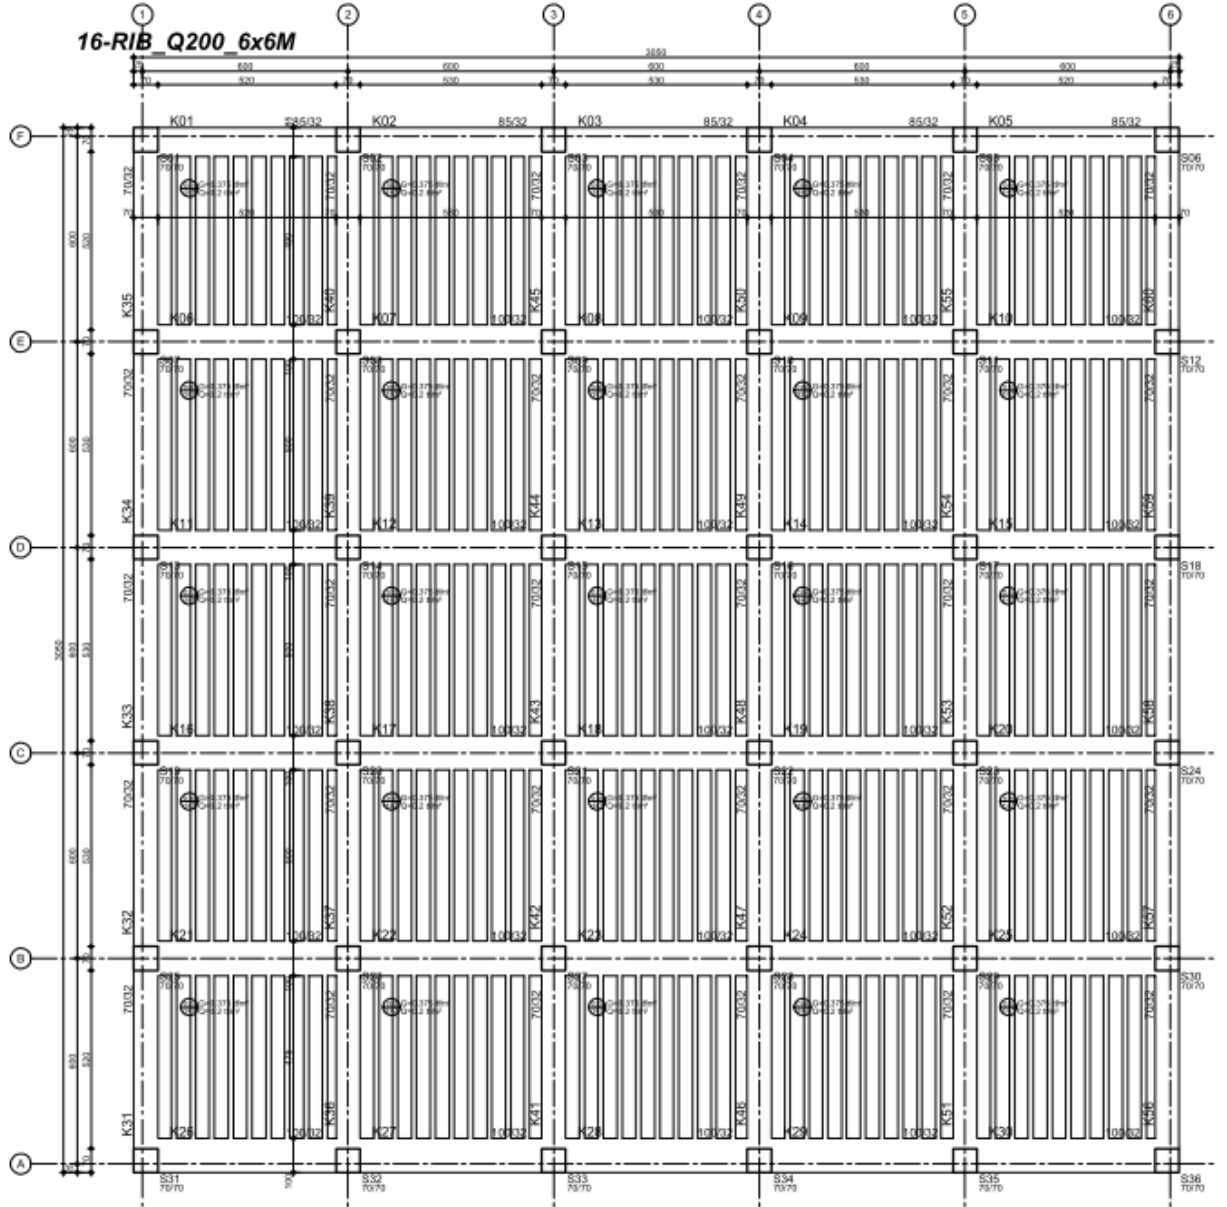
Kiriş Plak Sistem Örnek Kalıp Planı (BS)
